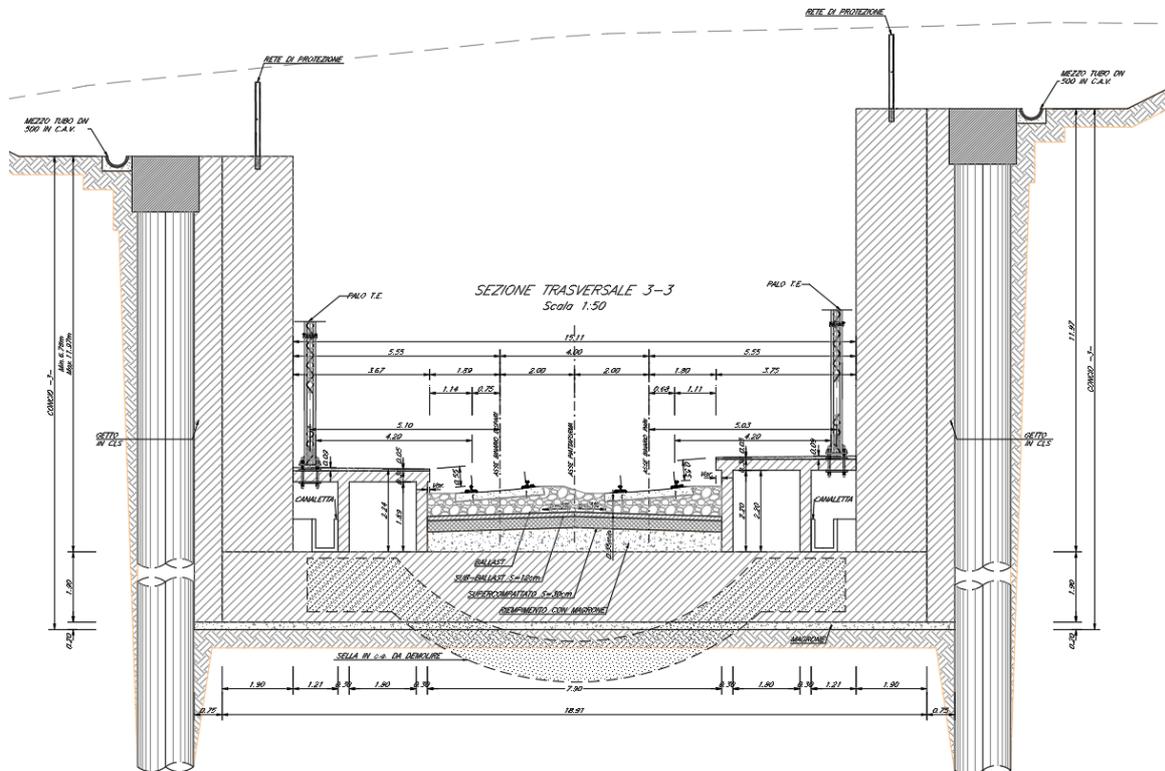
Sezione trasversale muro ad U (Concio 1) – Grottaminarda lato Bari
